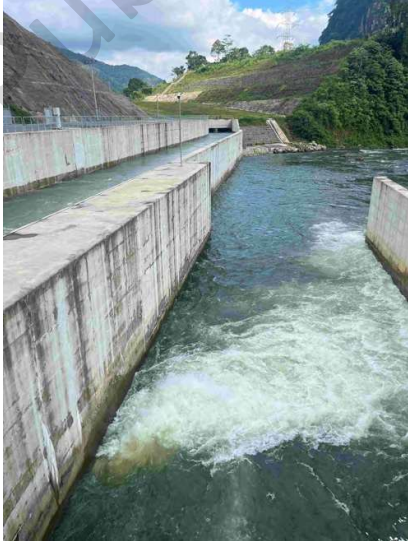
Alarm saat masuk	Foto 17: Dipotong untuk mengakomodasi saluran pembuangan air	Foto 18: : Saluran drainase silang sepanjang saluran utama
